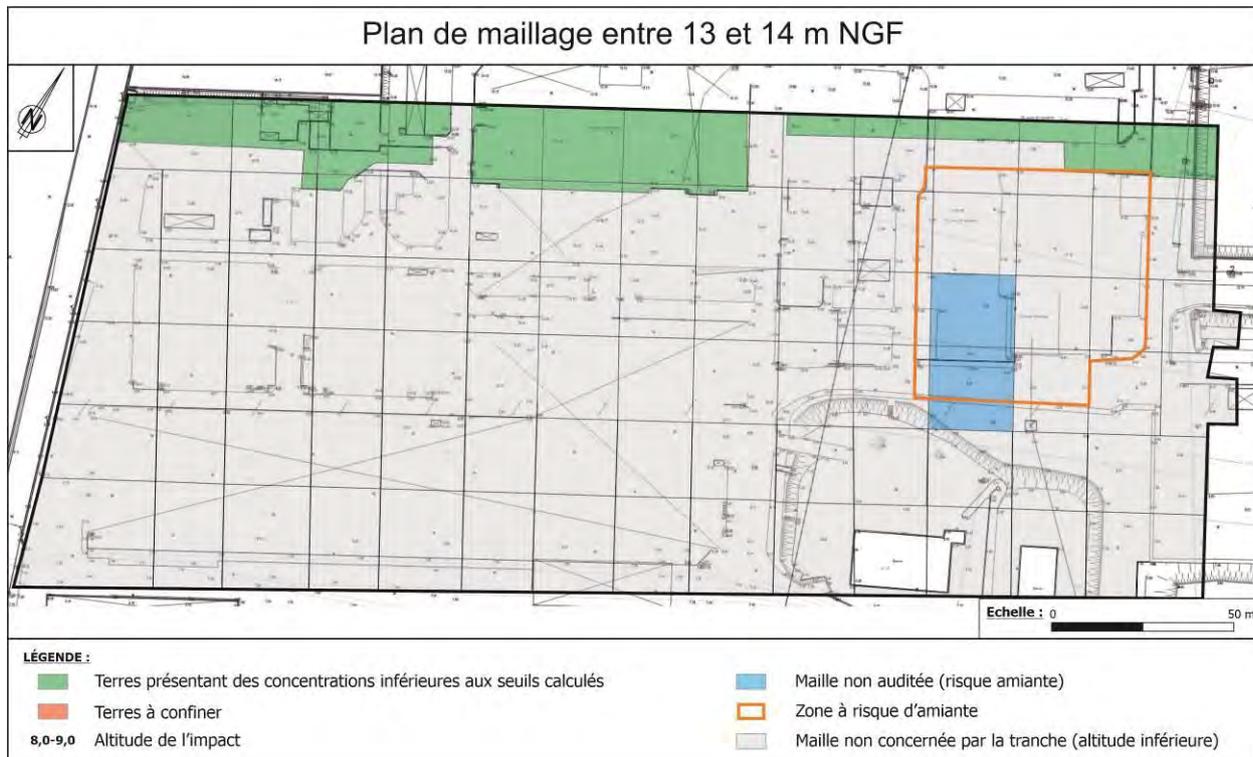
Plan de maillage entre 13 et 14 m NGF
